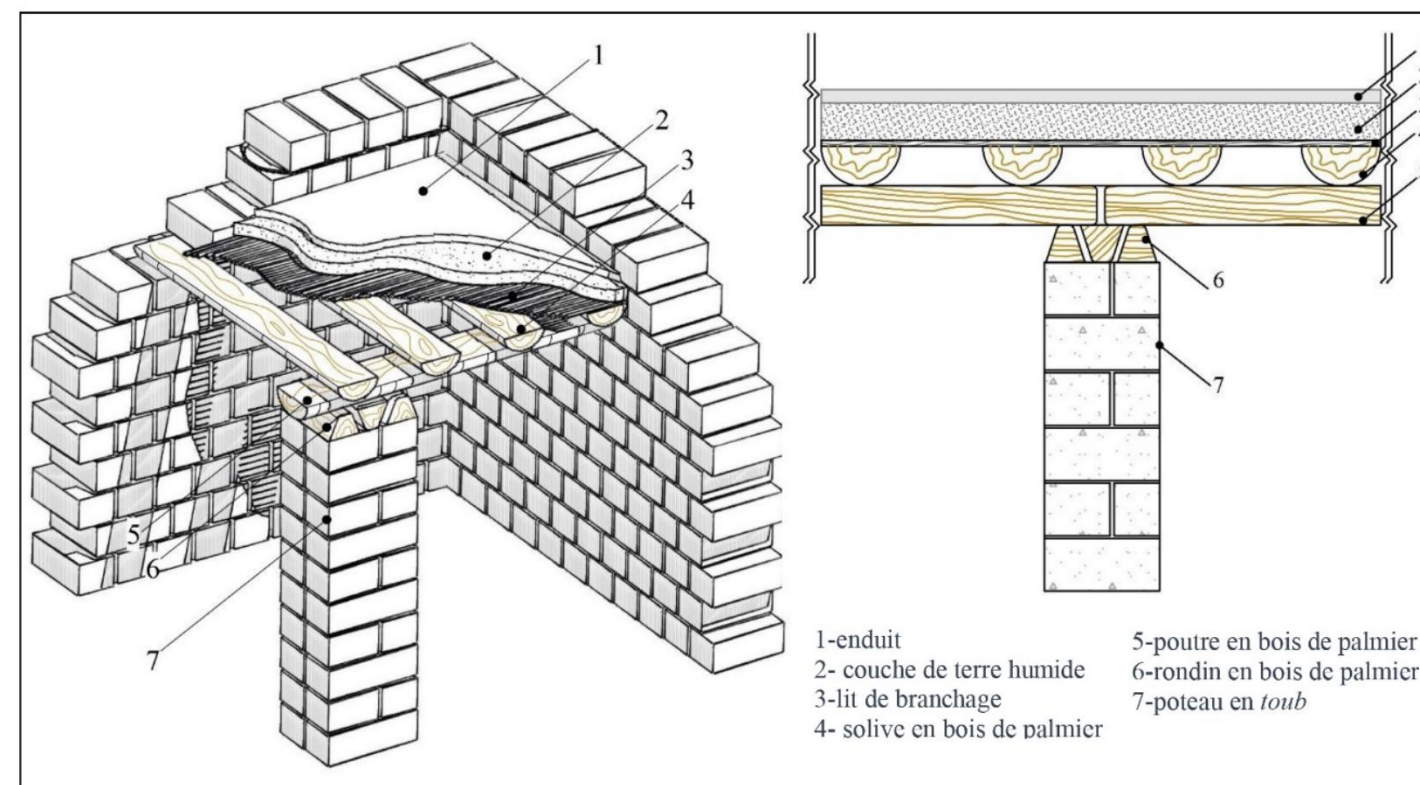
Axonométrie et coupe verticale du plancher traditionnel placé d'un côté sur un mur et de l'autre sur un poteau
